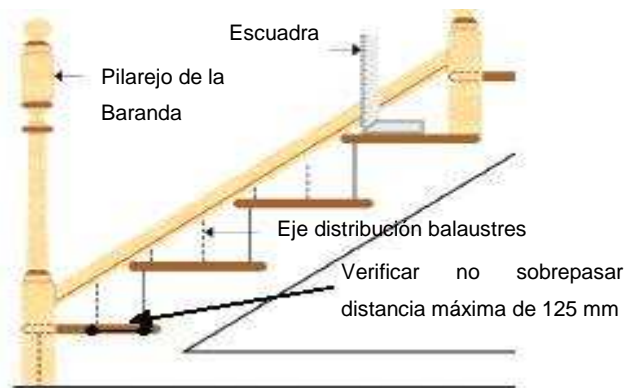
a. Armado de la baranda de la escalera. Se puede observar la colocación de los pilarejos y la presentación y forma de atraque del zócalo
